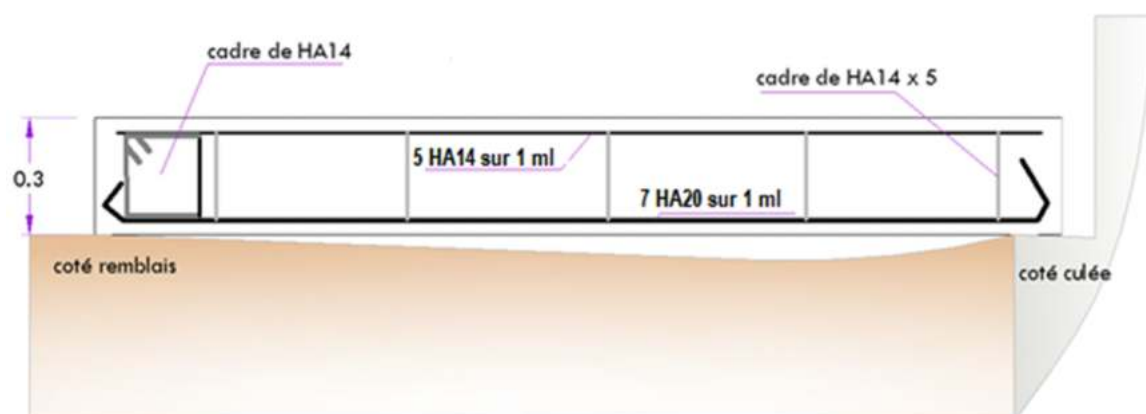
ferraille de la dalle de transition sur 1 ml
